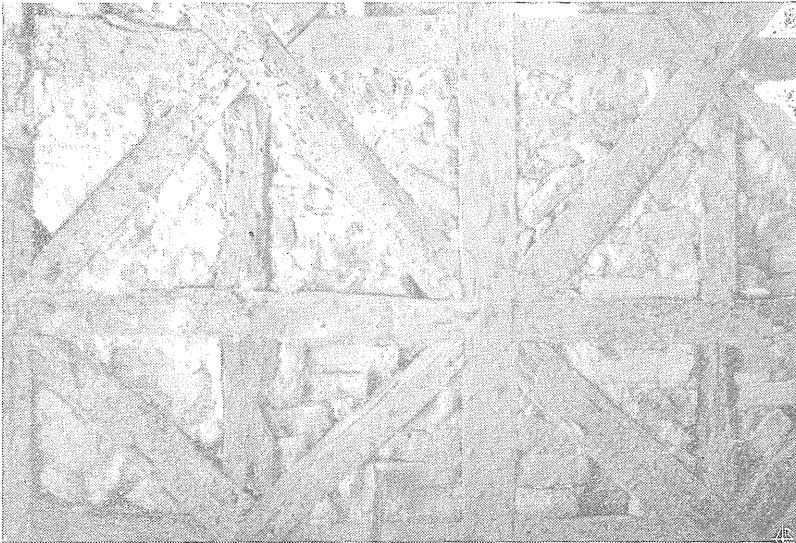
Porto — Bairro da Sé. Pormenor.
